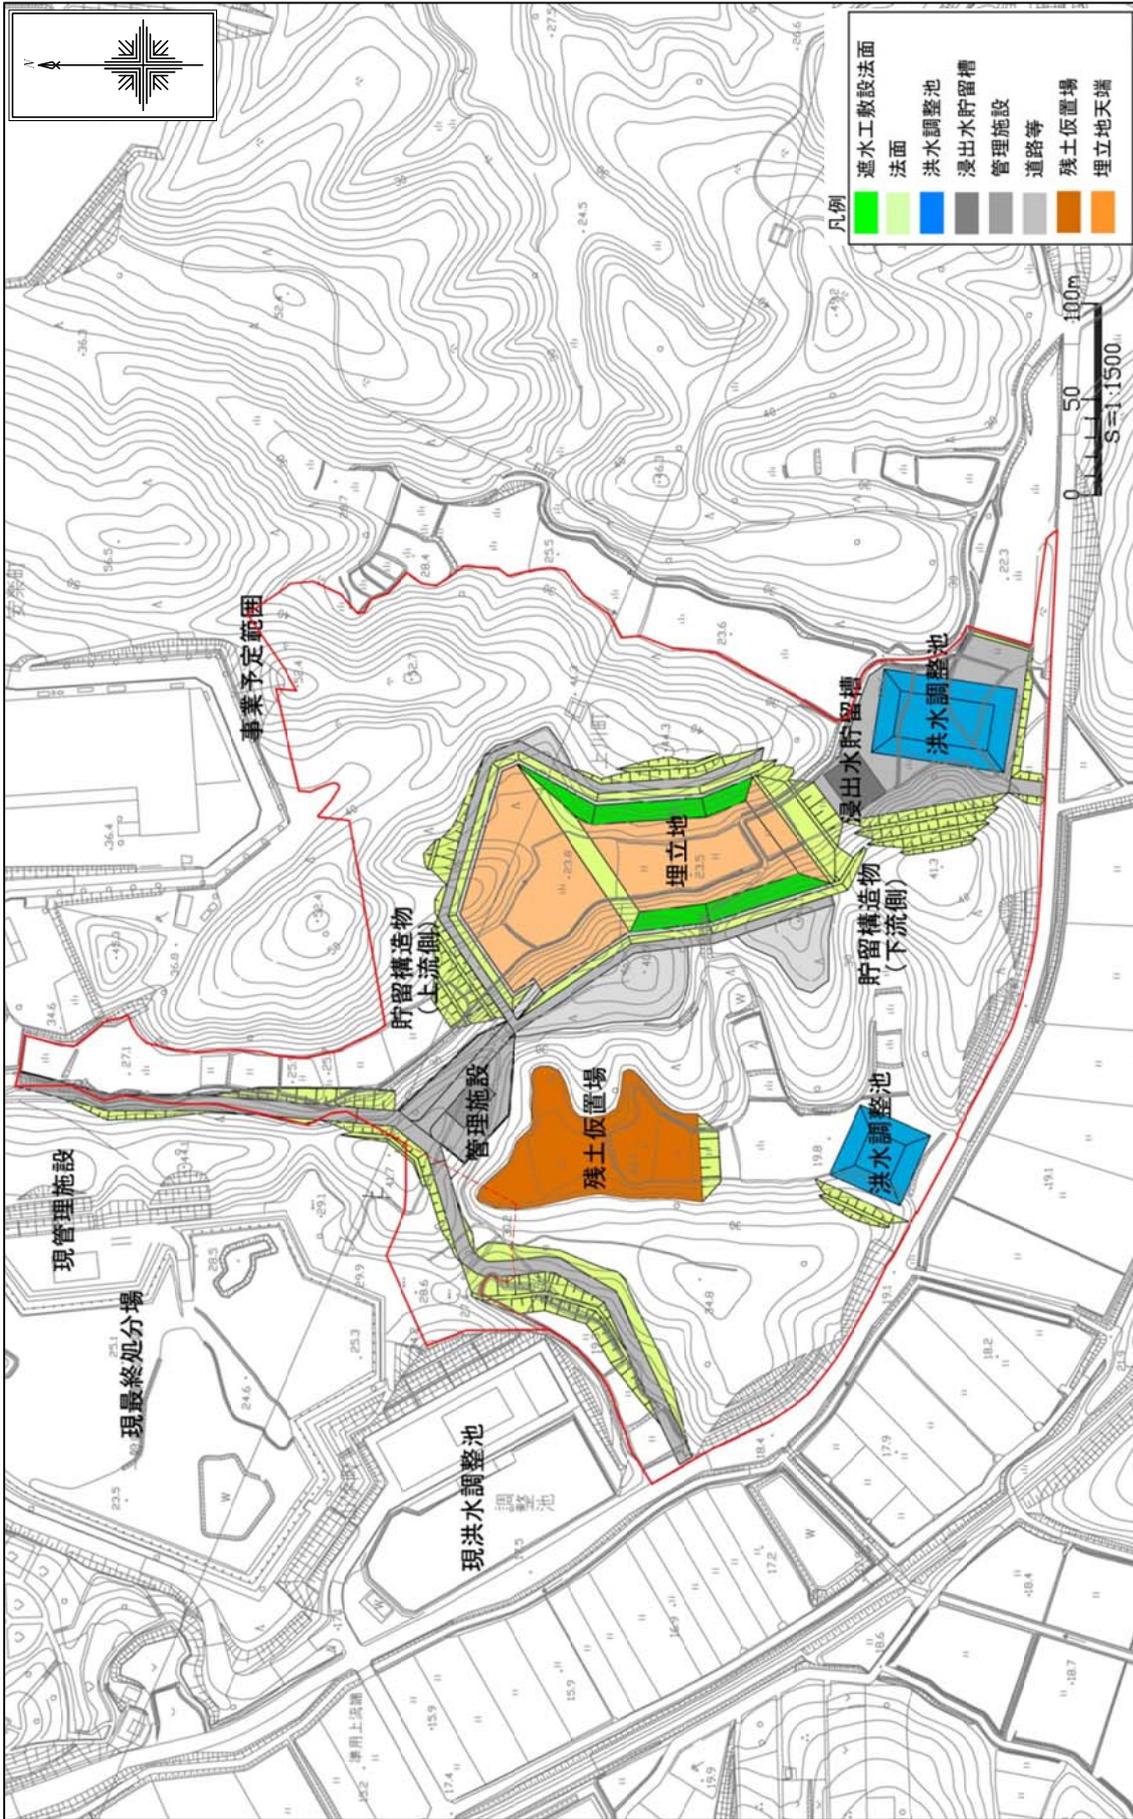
新最終処分場配置平面図 (第 3 期)
